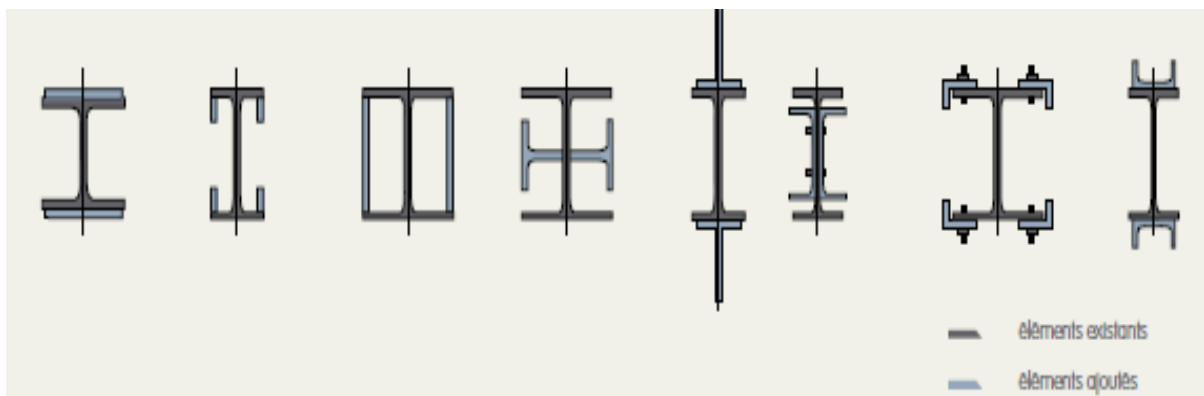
Renforcement de sections en acier par soudage ou boulonnage d'éléments en acier
